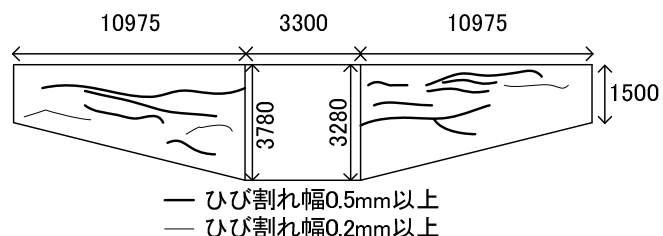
対象橋梁主要ひび割れ概要図（竣工後24年）
